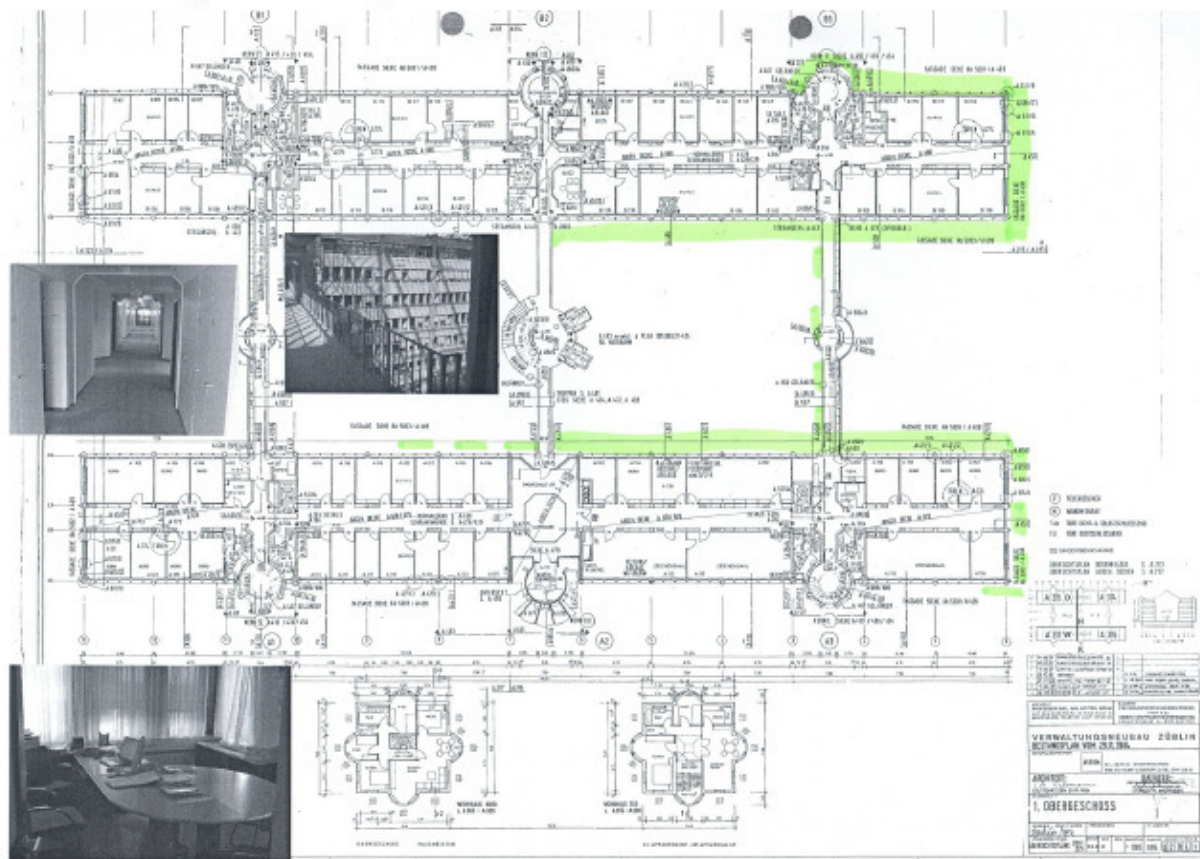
Grundriss – südlicher Teil – als Übersichtsplan zur Festlegung der zu vermessenden Bereiche
